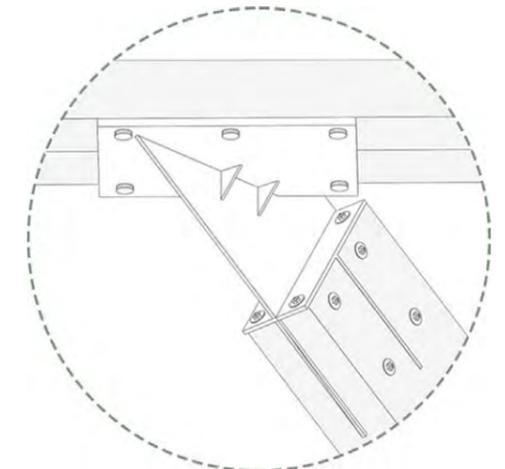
Detalles constructivos de pasarela central, evidenciando diferentes uniones. Planimetría de elaboración propia.
